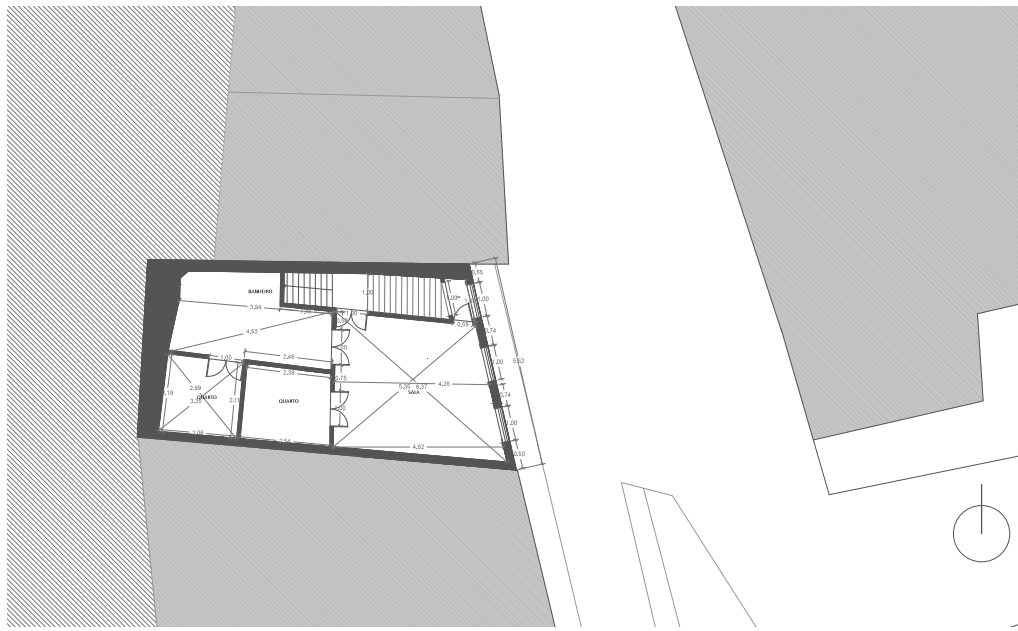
Levantamento de dimensões do piso 1, Escala 1/500
